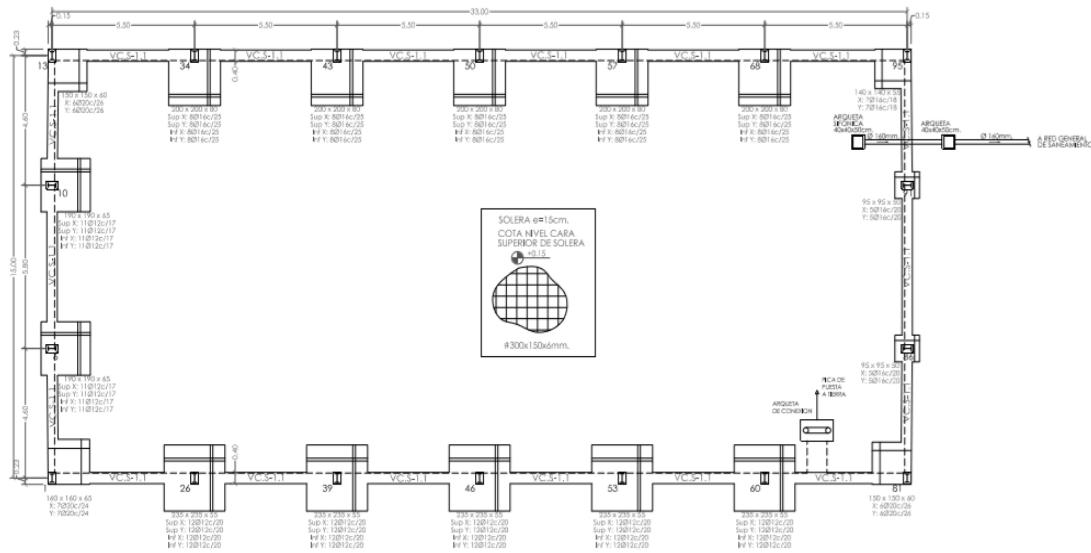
Planta de replanteo, cimentación saneamiento y puesta a tierra
